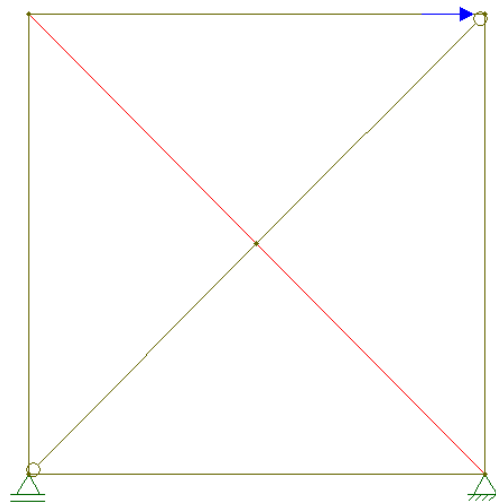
Estrutura de contraventamento no plano da cobertura.
